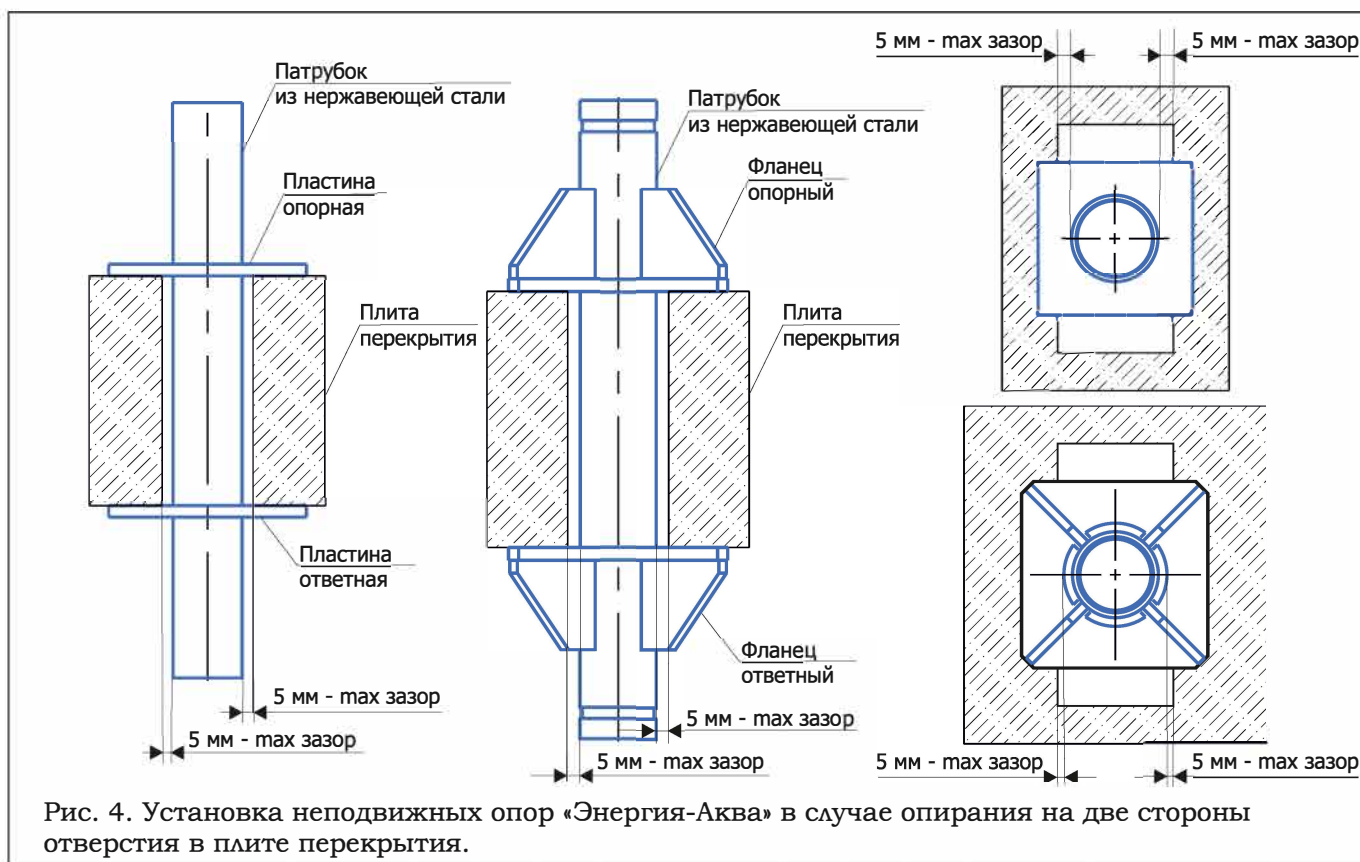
Установка неподвижных опор «Энергия-Аква» в случае опирания на две стороны отверстия в плите перекрытия.
